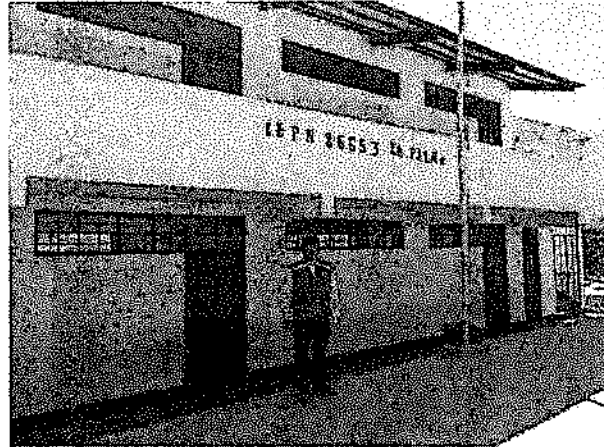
Se aprecia la vista posterior del pabellón 01,
